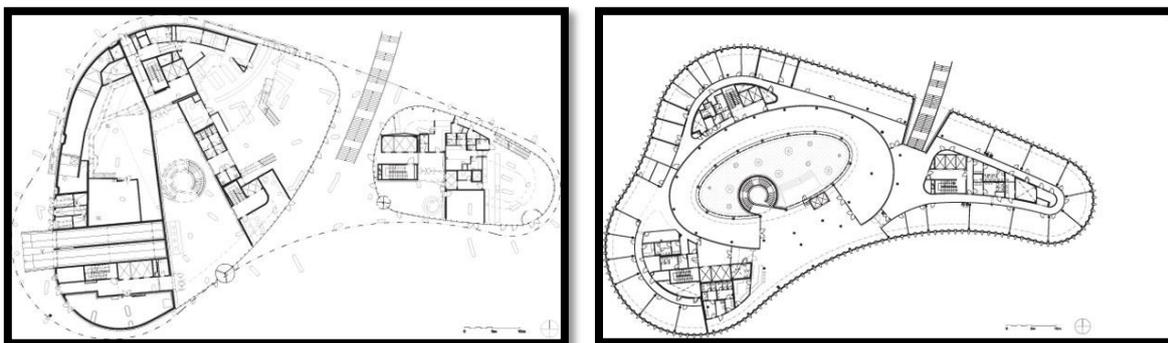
plan des étages supérieurs du centre d'affaire Main Point Karlin.
